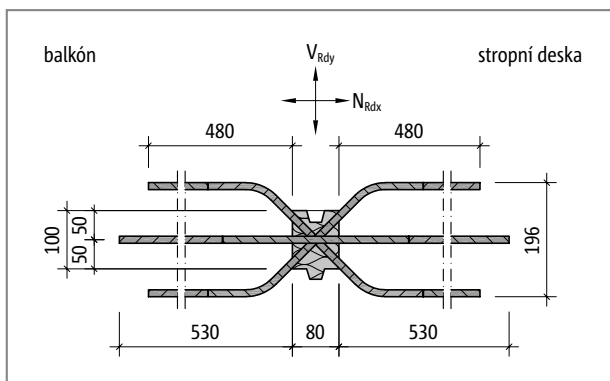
Schöck Isokorb® T typ HP-VV1-NN1: Řez prvku
